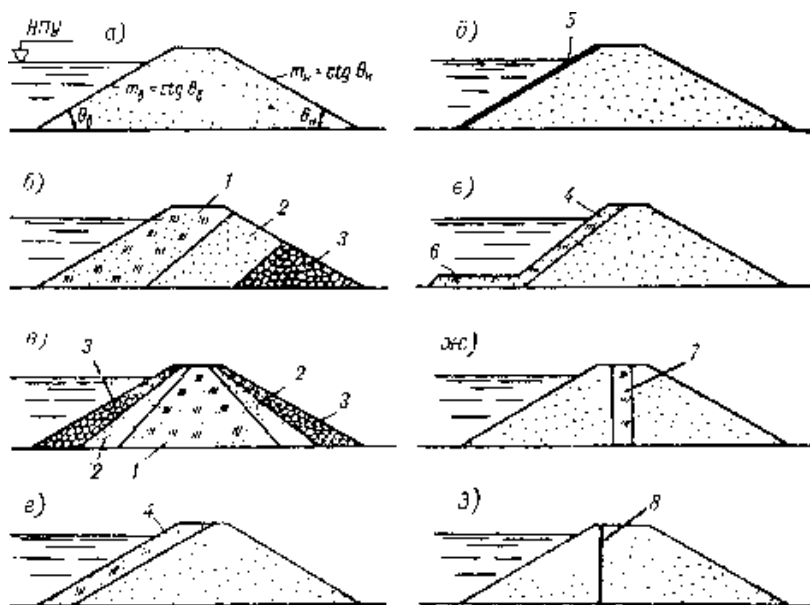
Основные типы земляных насыпных плотин (схемы): 1 – суглинок; 2 – песок; 3 – гравий; 4 – экран грунтовый; 5– экран из негрунтового материала; 6 – понур; 7 – ядро; 8 – диафрагма
